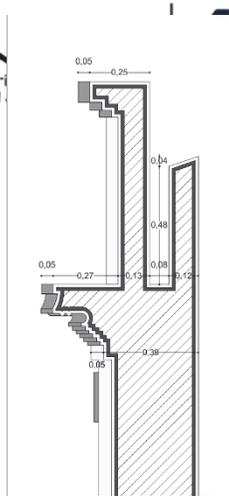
Sección D-D, detalle cornisa, Estación del ferrocarril Sur.
